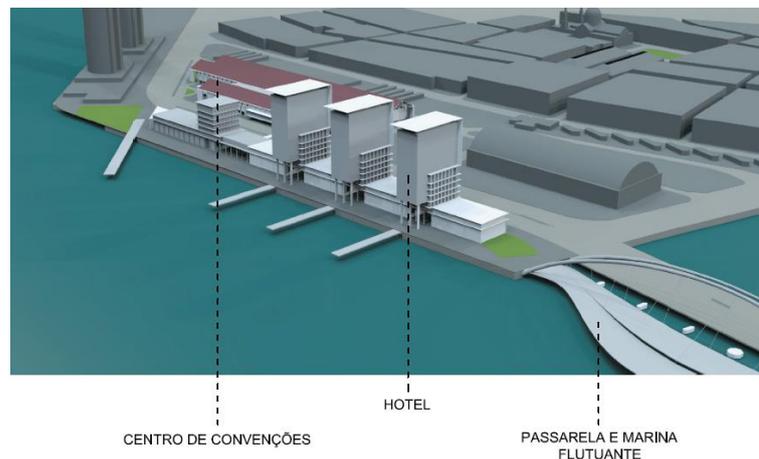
Vista do centro de convenções, hotel, passarela e marina.
